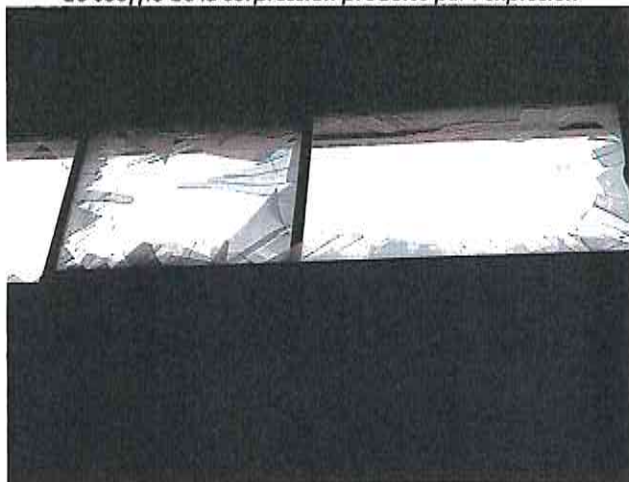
vitres hautes du bâtiment, brisées par le souffle
